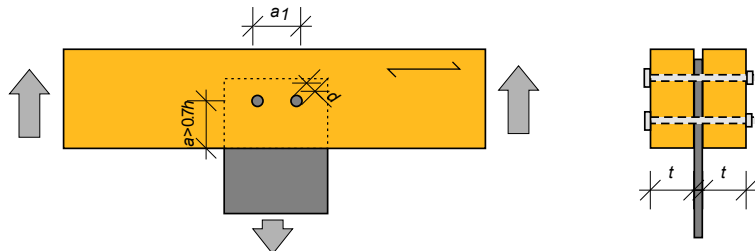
Versuchsreihen mit Passbolzen senkrecht zur Faserrichtung und geschlitztem Stahlblech
